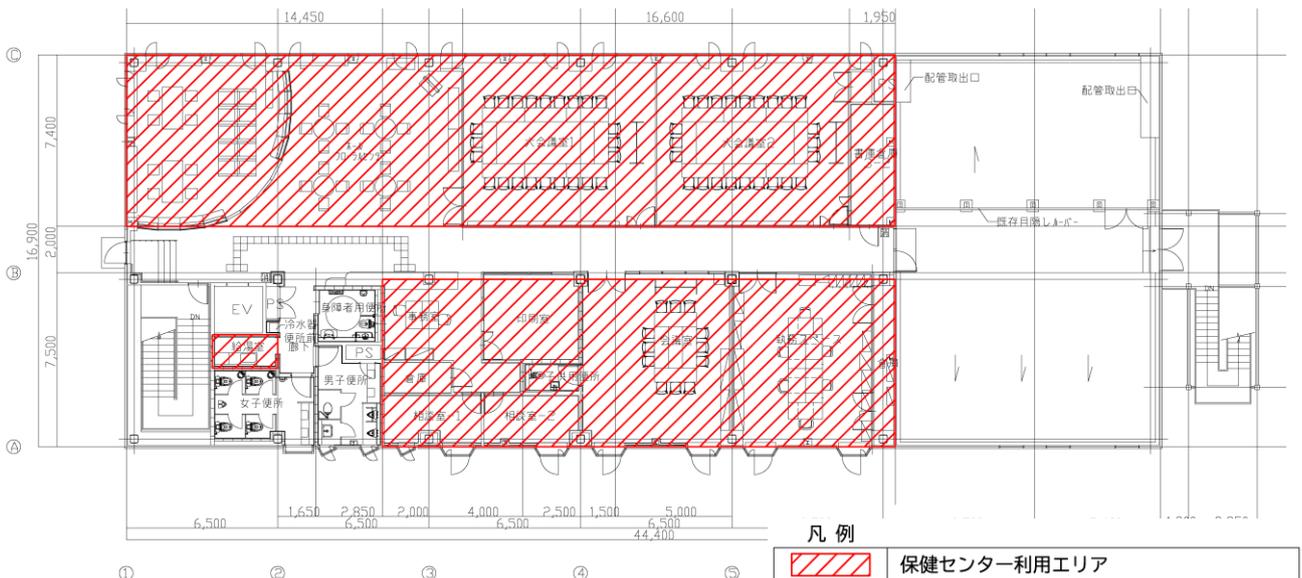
市役所別館 3 階 機能配置図 (案)
